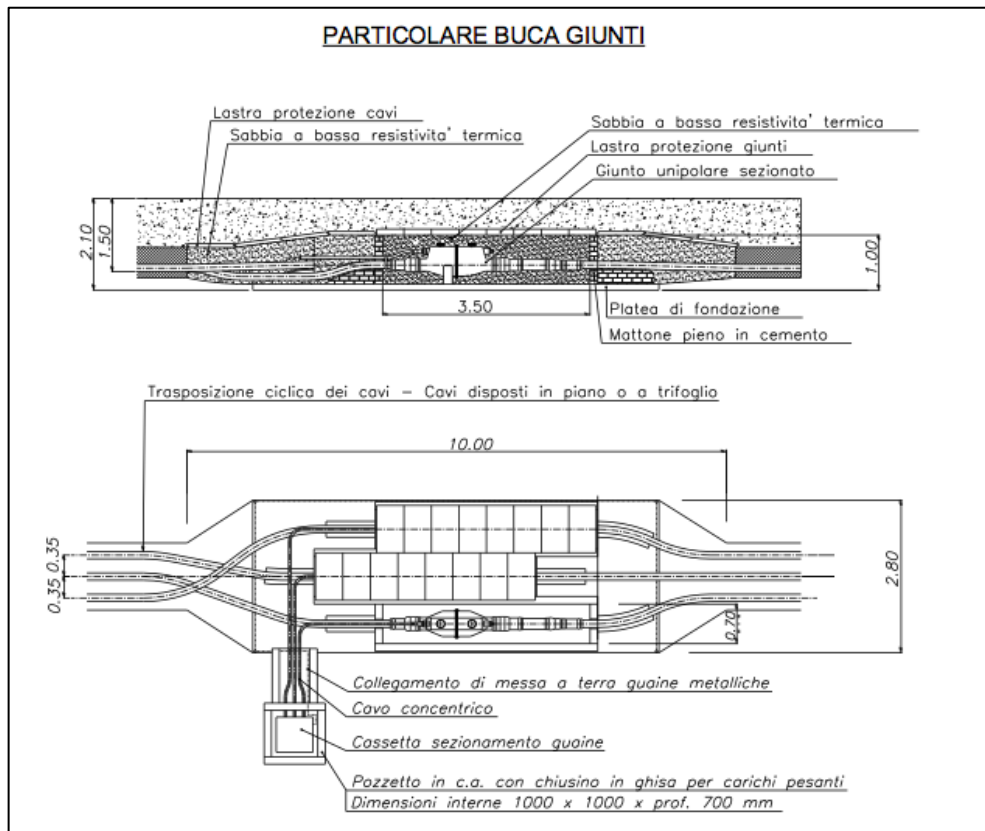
Tipo Camera Giunti: Sezione e Pianta
